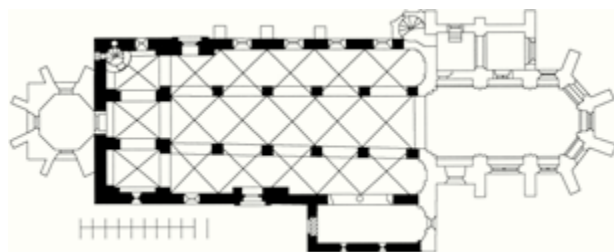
Grundriss der Pfarrkirche in Bad Deutsch Altenburg mit Hervorhebung der Bauteile des 13. Jahrhunderts
